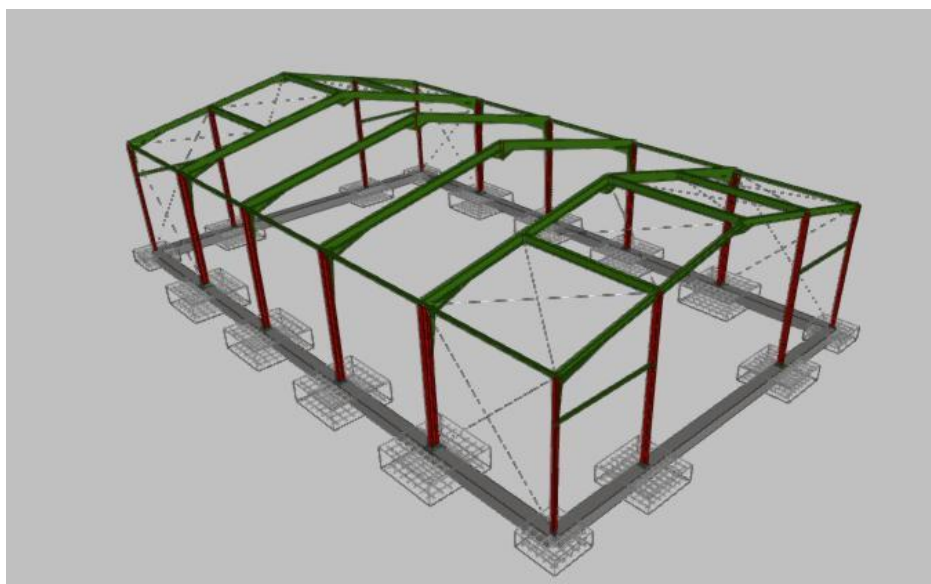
Vista 3D de la construcción. Fuente: Elaboración propia (CYPE)
